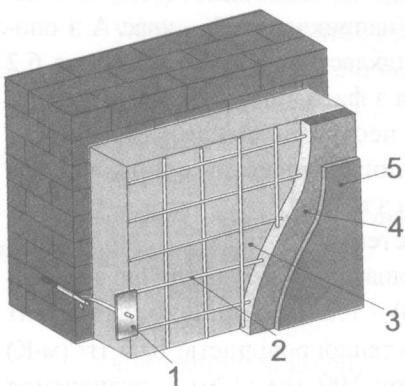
Система влаштування фасаду системи скріпленої теплоізоляції:
